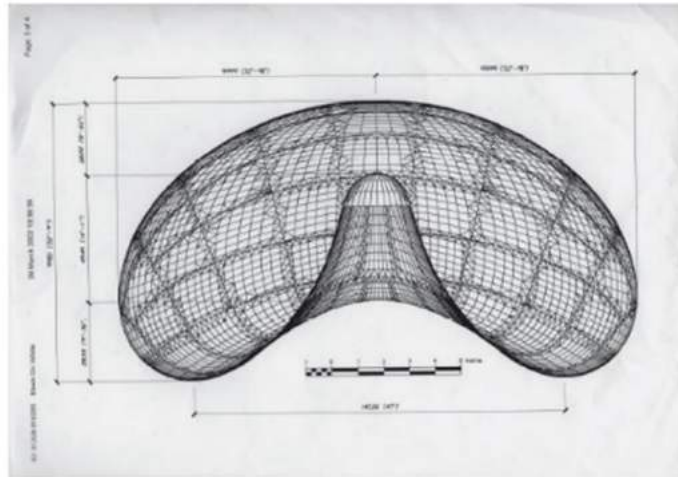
Чертеж конструкции «Клауд Гейт»
